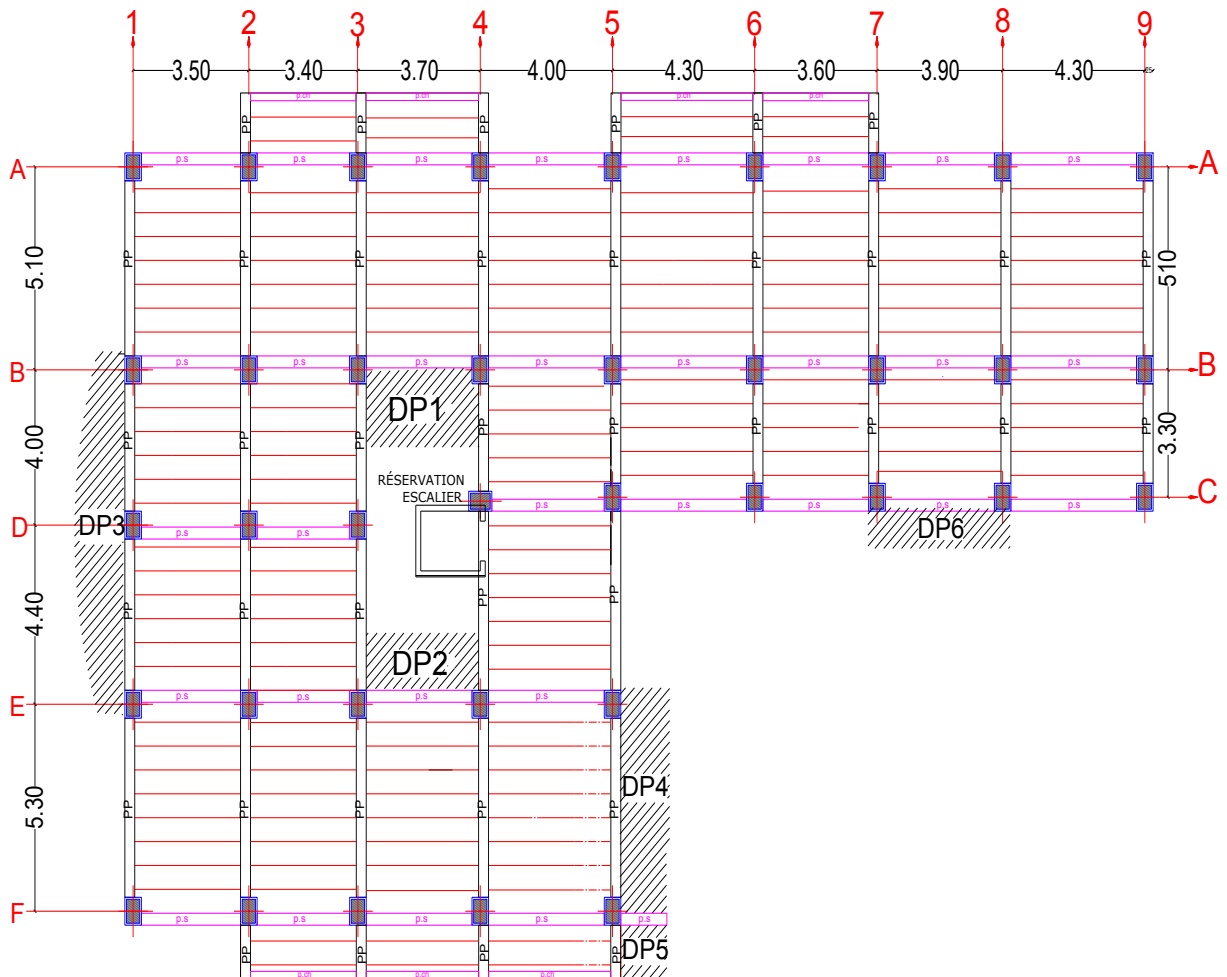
la disposition des poutrelles au niveau de l'étage courant (niveau 1)
